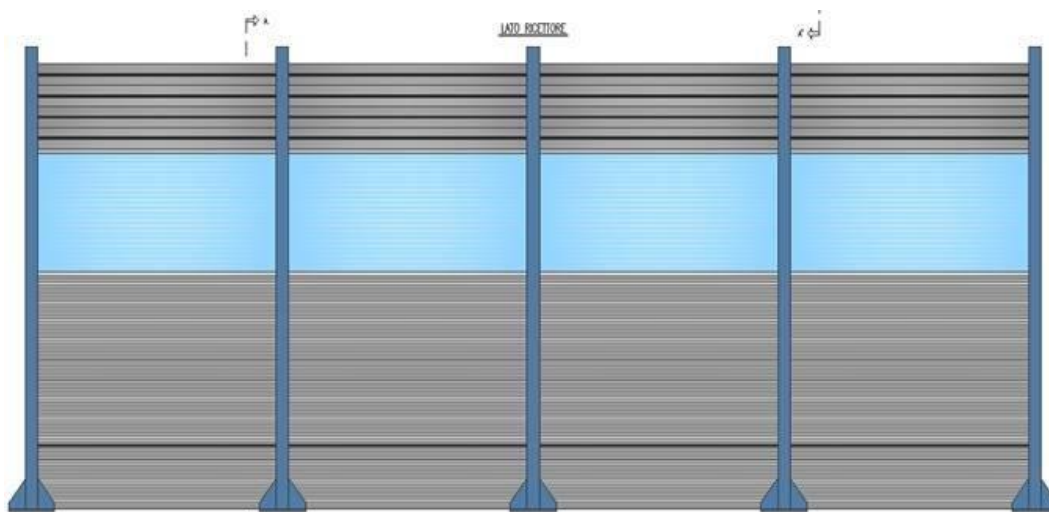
Barriera acustica tipo – opaca con elementi trasparenti
